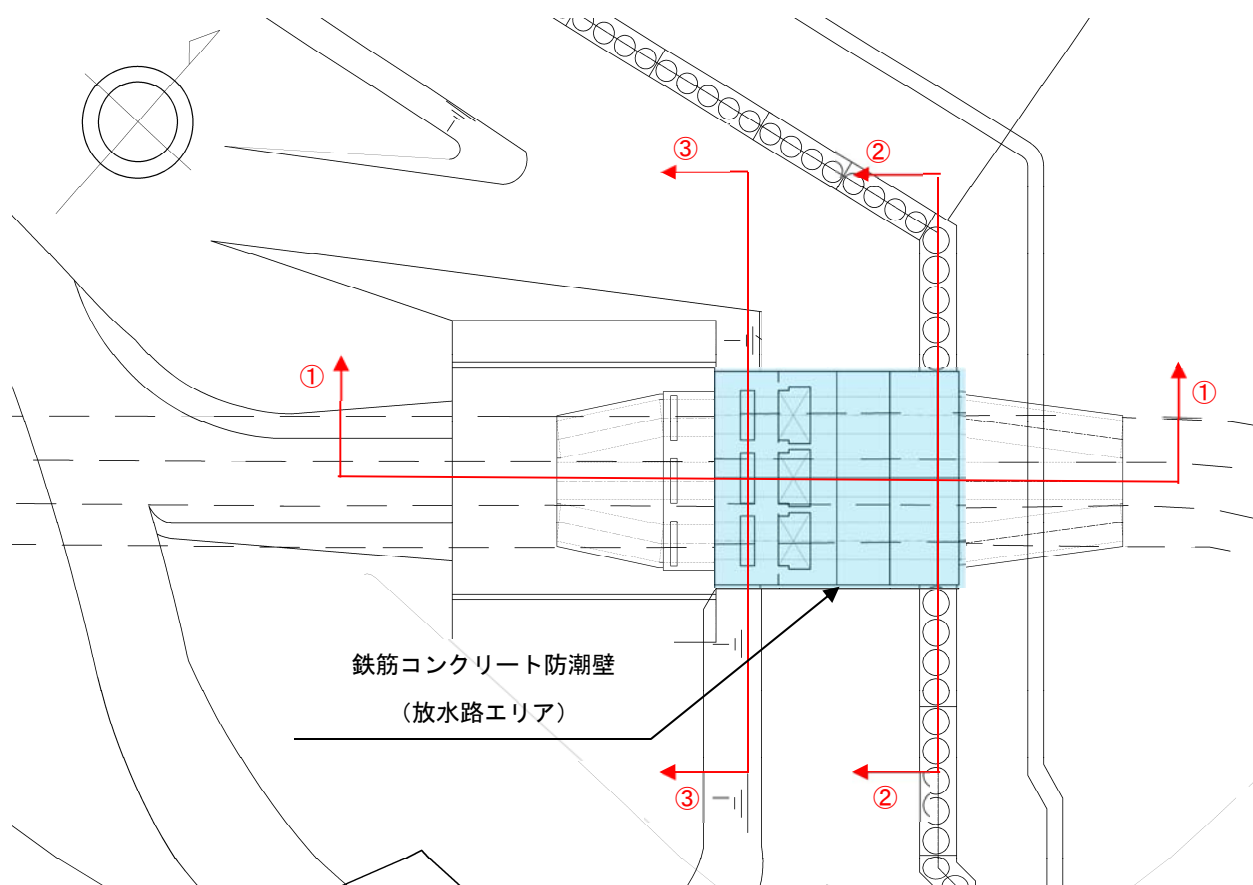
鉄筋コンクリート防潮壁（放水路エリア）の評価対象断面位置図
